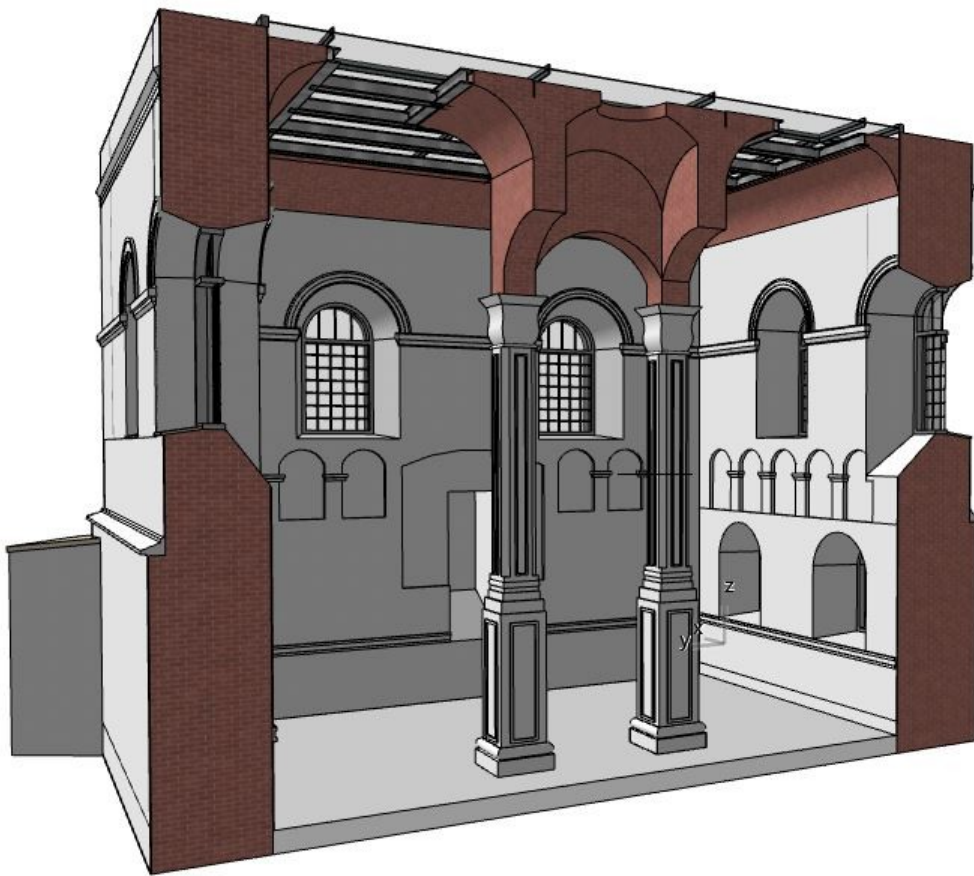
Rekonstruktion Aufbau 3D Schnitt
